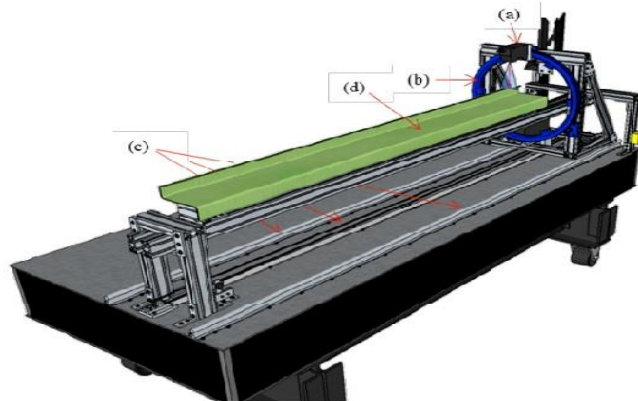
Plate-forme de mesure des imperfections utilisée par Zhao, Tootkaboni et Schafer (2017) ; (a) scanner laser ; (b) platine rotative ; (c) système de mouvement linéaire ; (d) spécimen [26].
